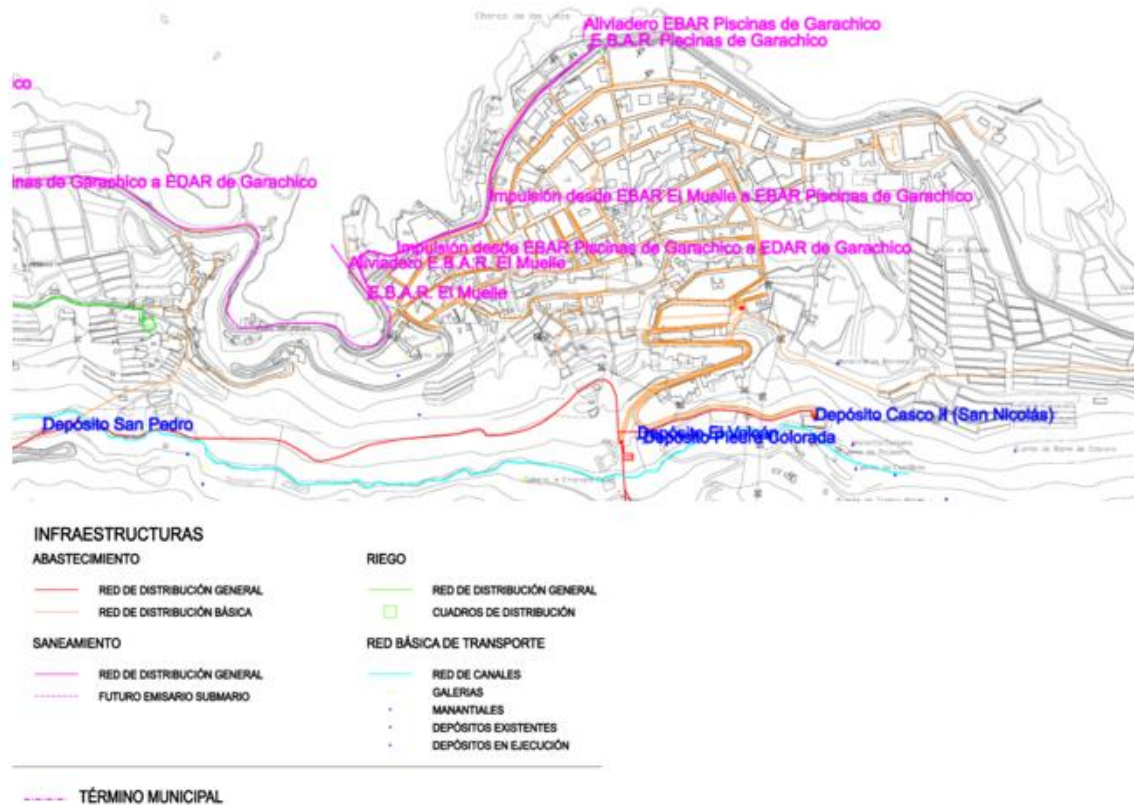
Detalle plano y leyenda Plano O.4 "Infraestructuras" Fuente: PGO
